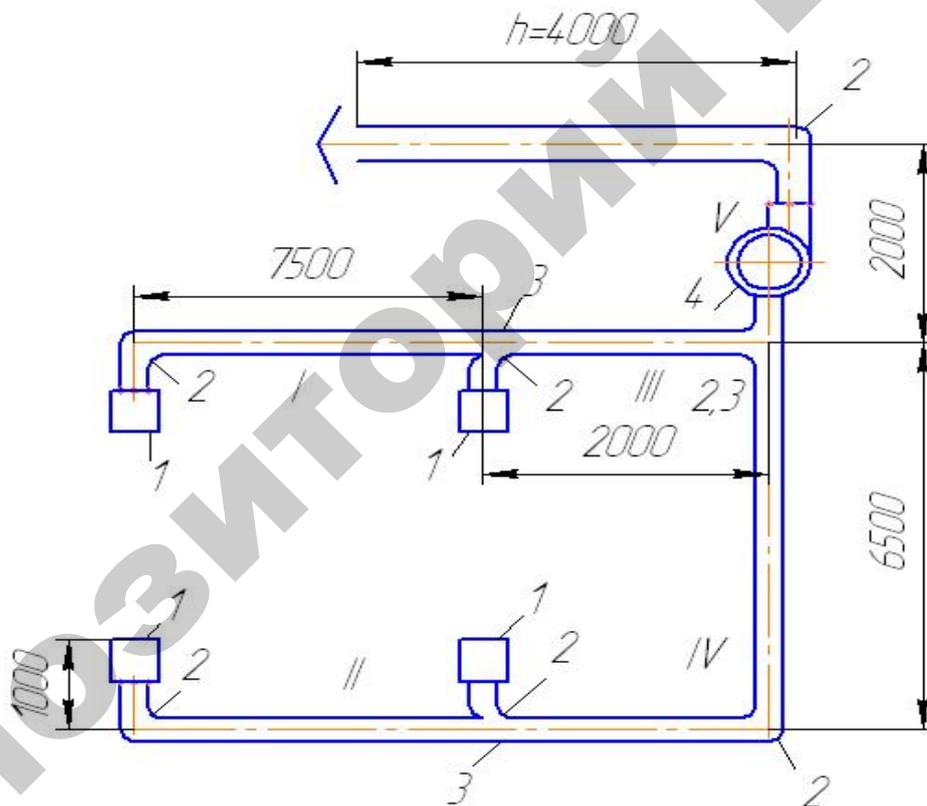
Схема вытяжной сети системы вентиляции:
